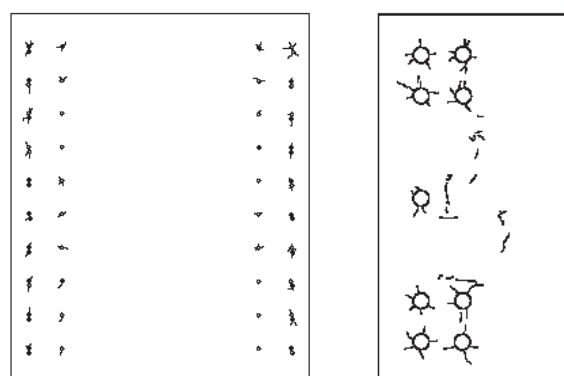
夏期打設の試験体断面のひび割れ（丸山）
